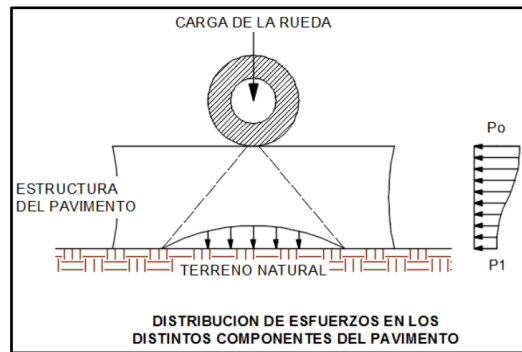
Distribución e incremento de los esfuerzos de un pavimento flexible.
